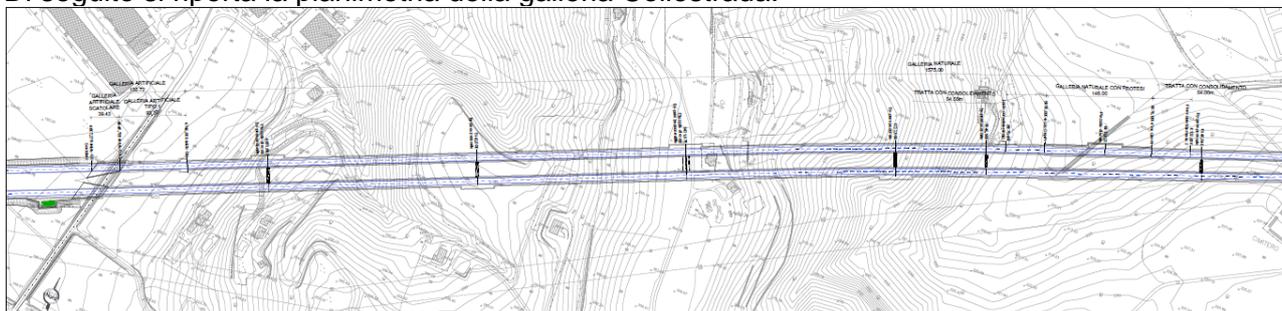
Stralcio planimetrico della galleria con vista su imbocco sud
